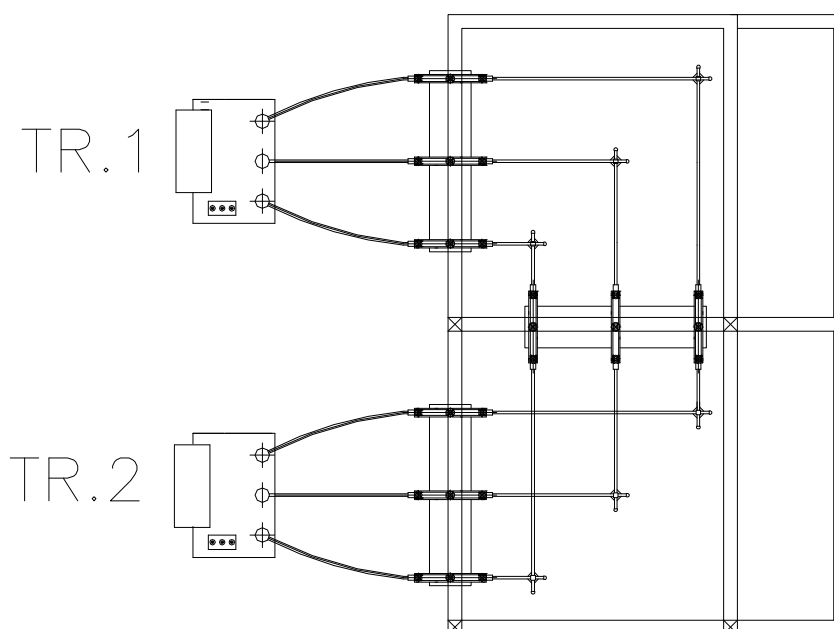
Planta do barramento e transformadores da SE de 138 kV
